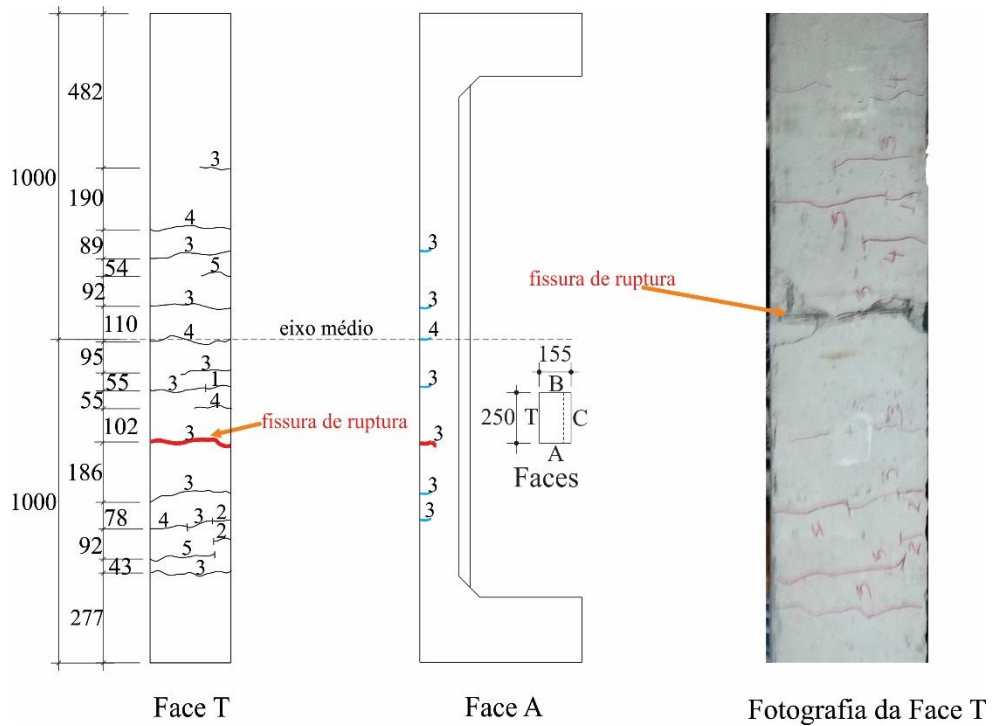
55 - Fissuras nas Faces T e A; Fotografia da face T - pilar PPBA-150-26
